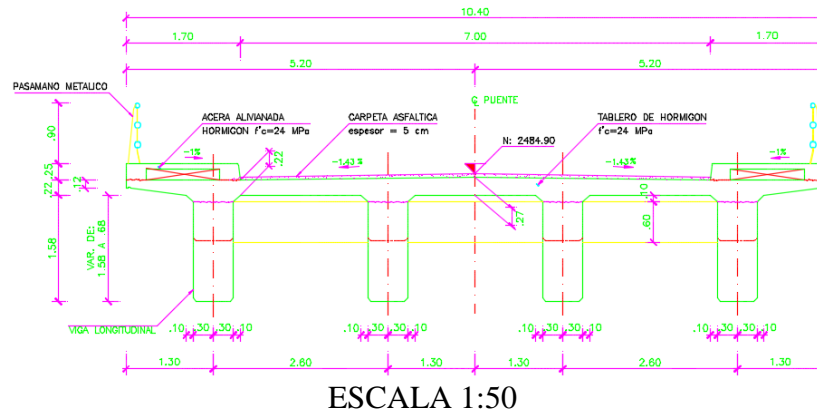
Corte transversal puent de hormigón armado Isla Santiafo.
